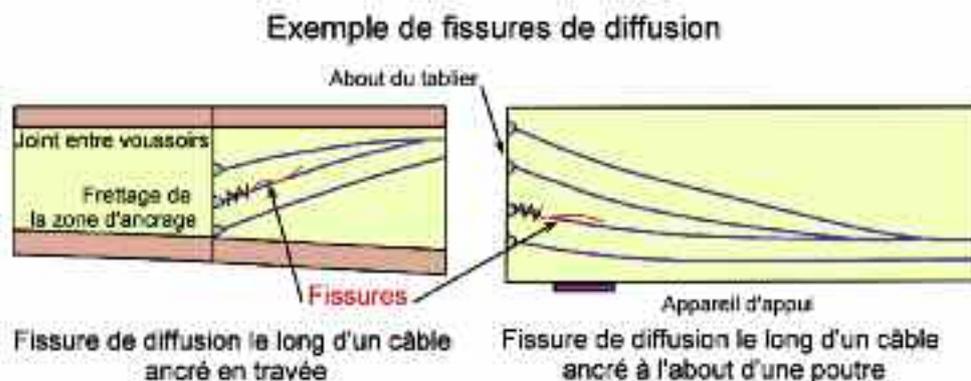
fissures d'éclatement le long du tracé des armatures de BP
